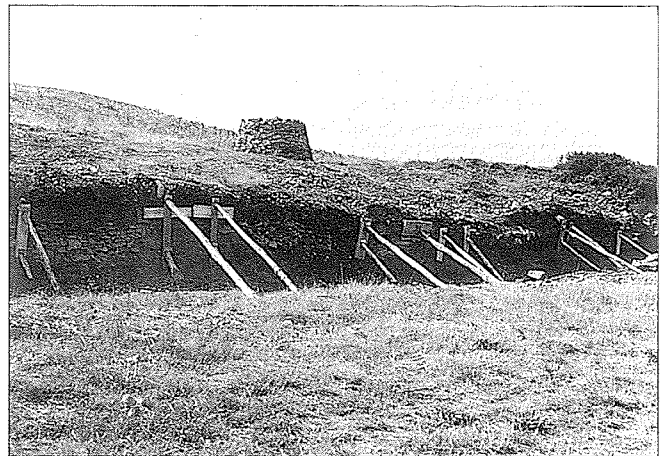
Consolidación y entibado de la muralla norte en el sector excavado.
